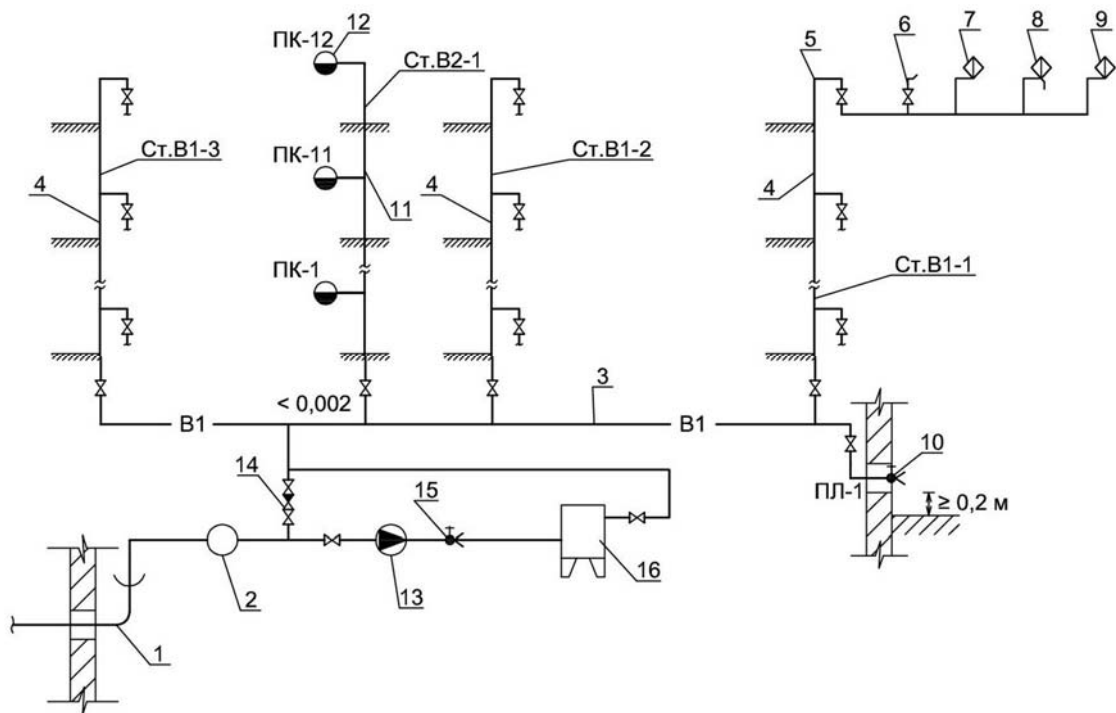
Схема внутрішнього холодного водопроводу з насосом і гідропневмобаком:
